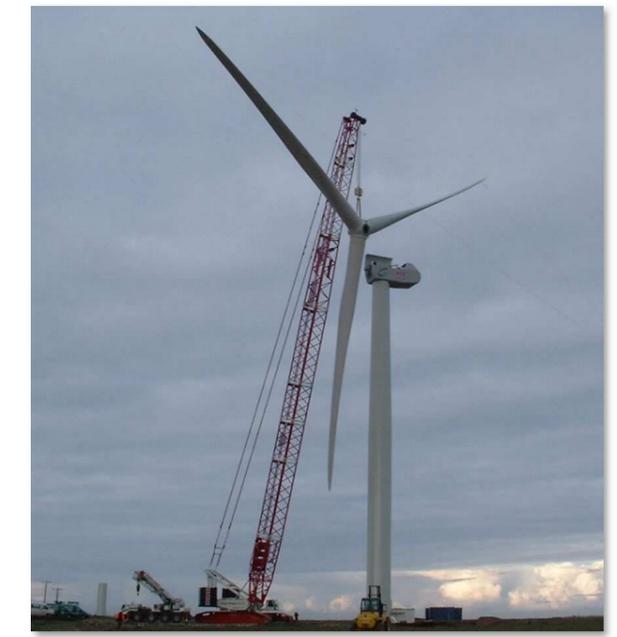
Mise en place du rotor tripale (Photo : VALOREM)
